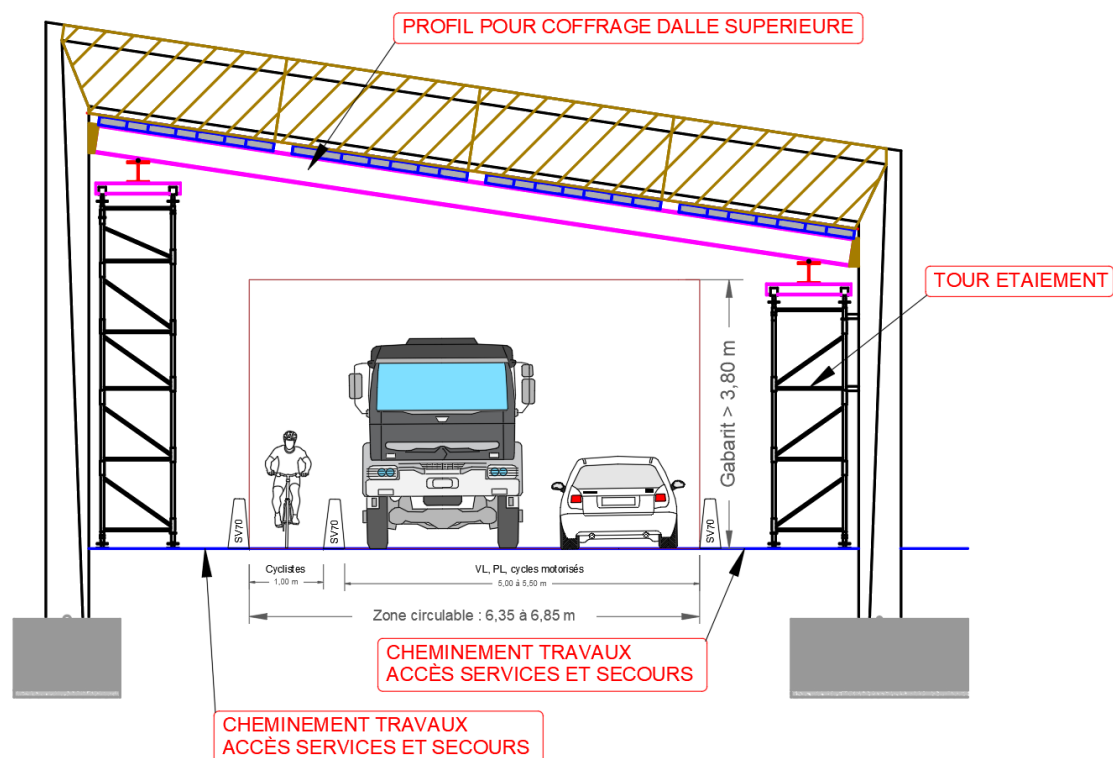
Vue en élévation du coffrage des têtes d'ouvrage
